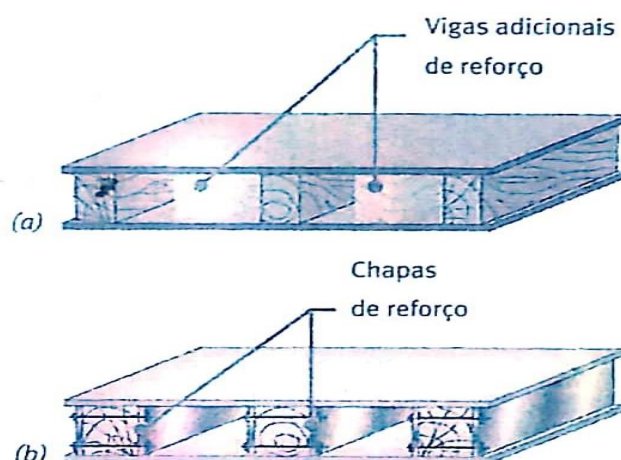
Reforço de resistência de pavimento com novas vigas de madeira e chapas de aço [9]
